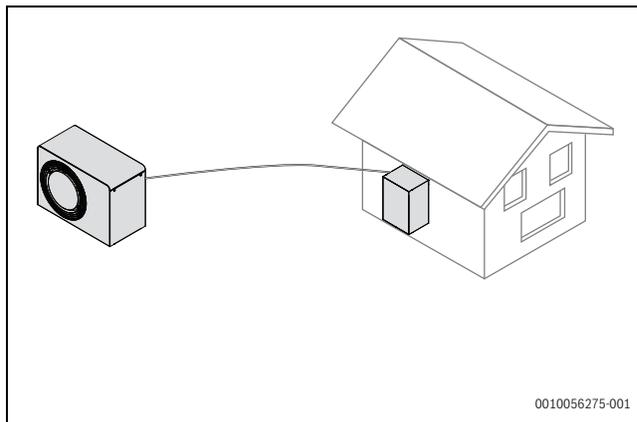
Collegamento CAN-BUS tra l'unità interna e l'unità esterna
